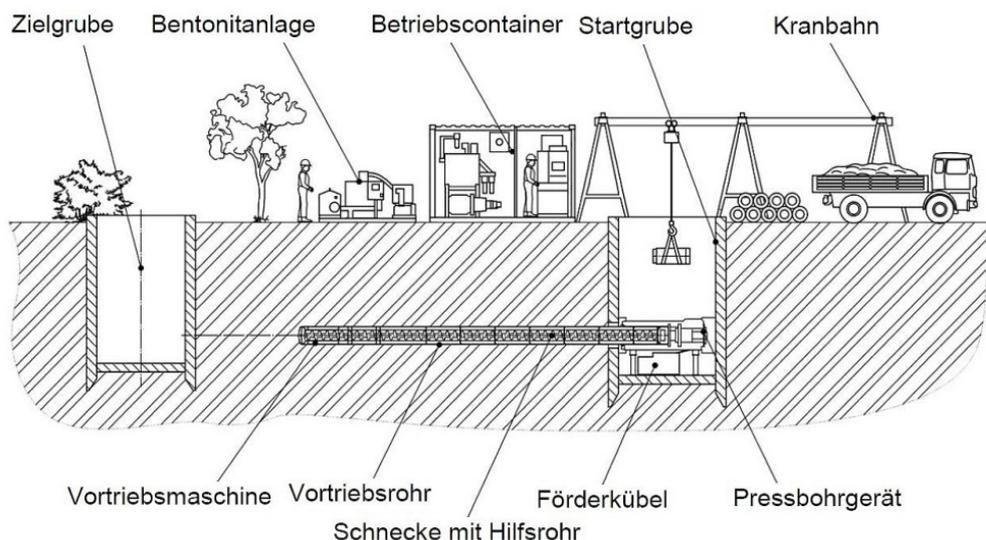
Beispiel Mikrotunnelbau mit Schneckenförderung, Quelle: DWA 2008
